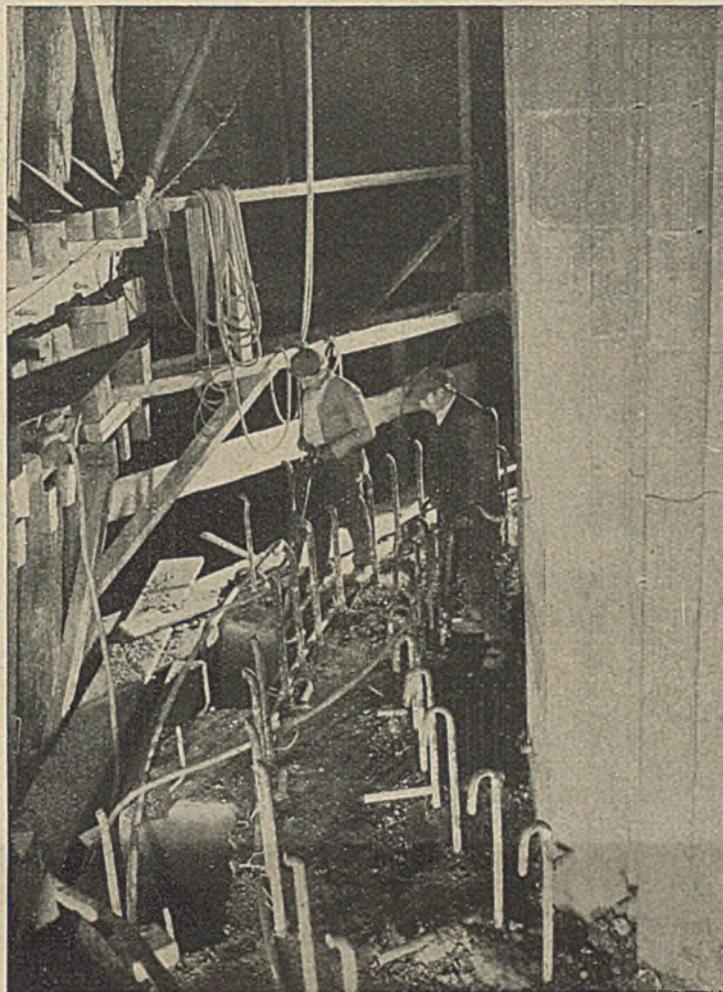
Schluß der Arbeiten 1926: Abbruch des Eisenbetonmantels um den Turmpfeiler A.
